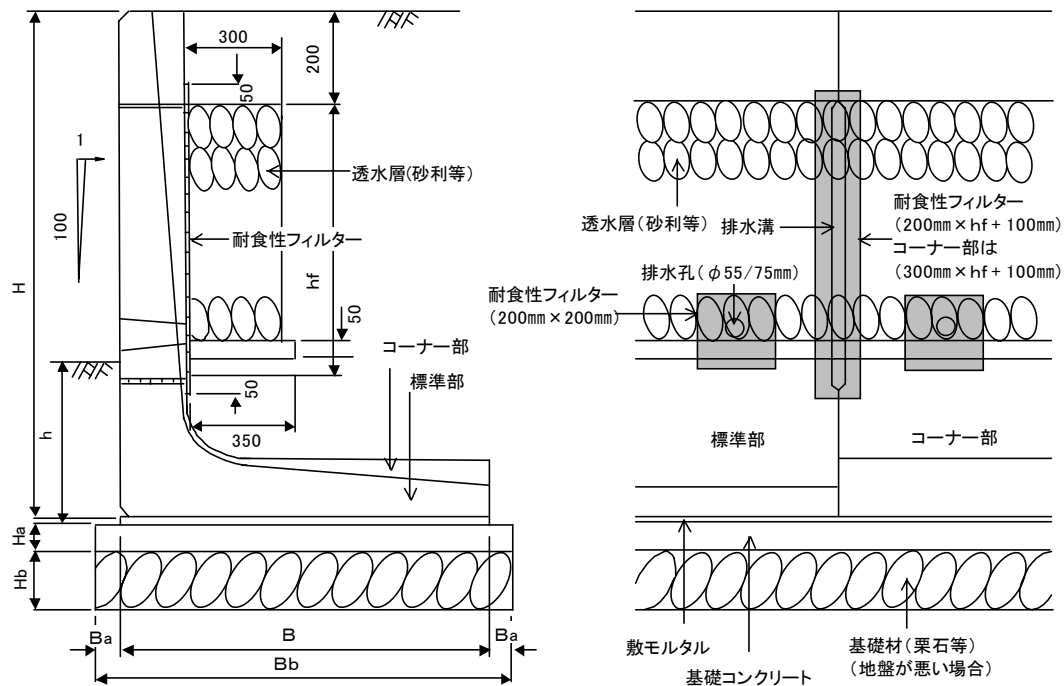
フィルター材の貼付け、止水コンクリートおよび透水層の施工図 (例)
